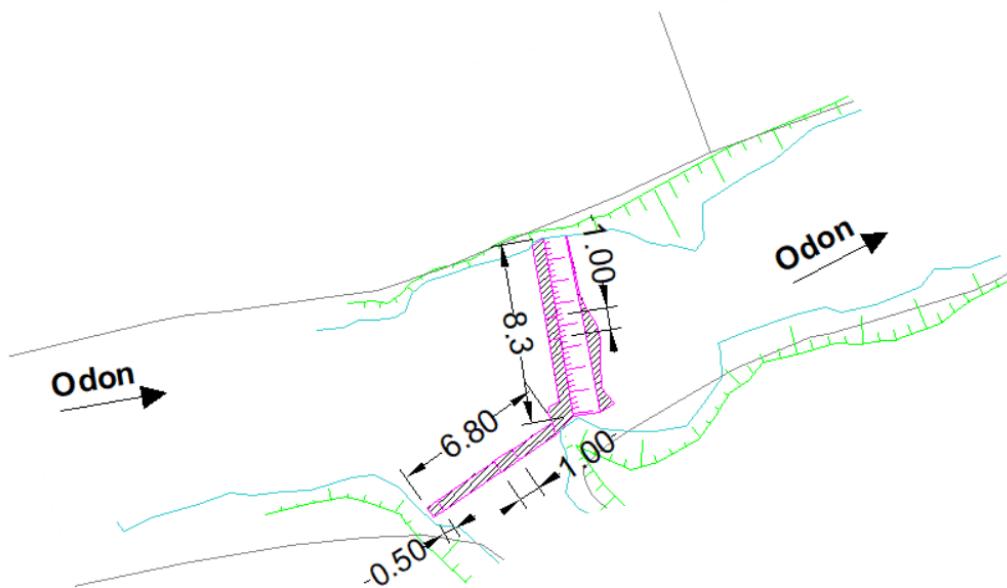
Vue en plan de l'ouvrage des Pierres ferrées (source : MN'EAU)
